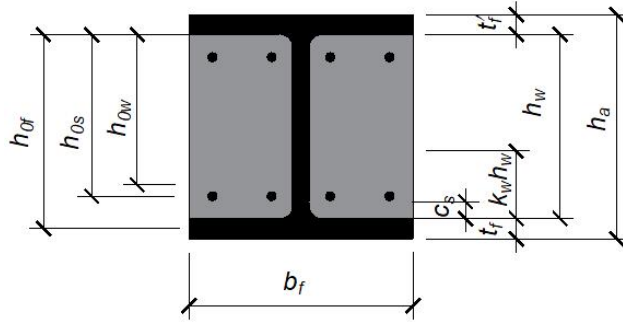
部分填充钢-混凝土无楼板组合梁最大裂缝宽度计算参数示意
